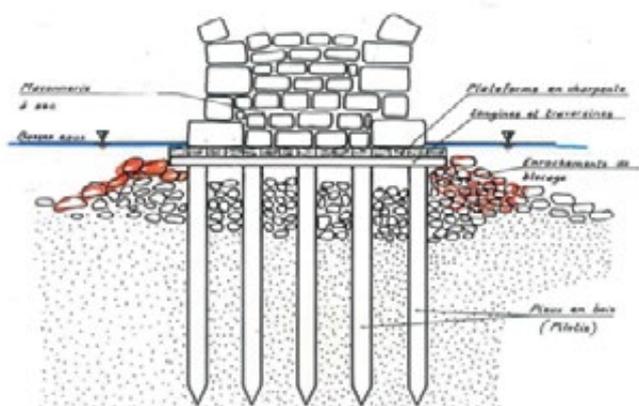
Fondation sur plancher bois et pieux battus contreventés par des enrochements (crédit J-P Levillain)
